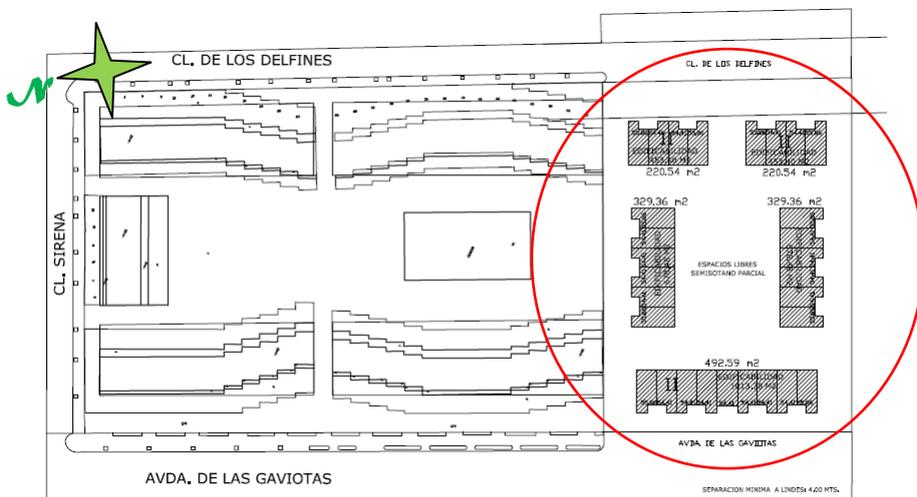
Plano situación de los bloques en la parcela. P. ejecución 2006
